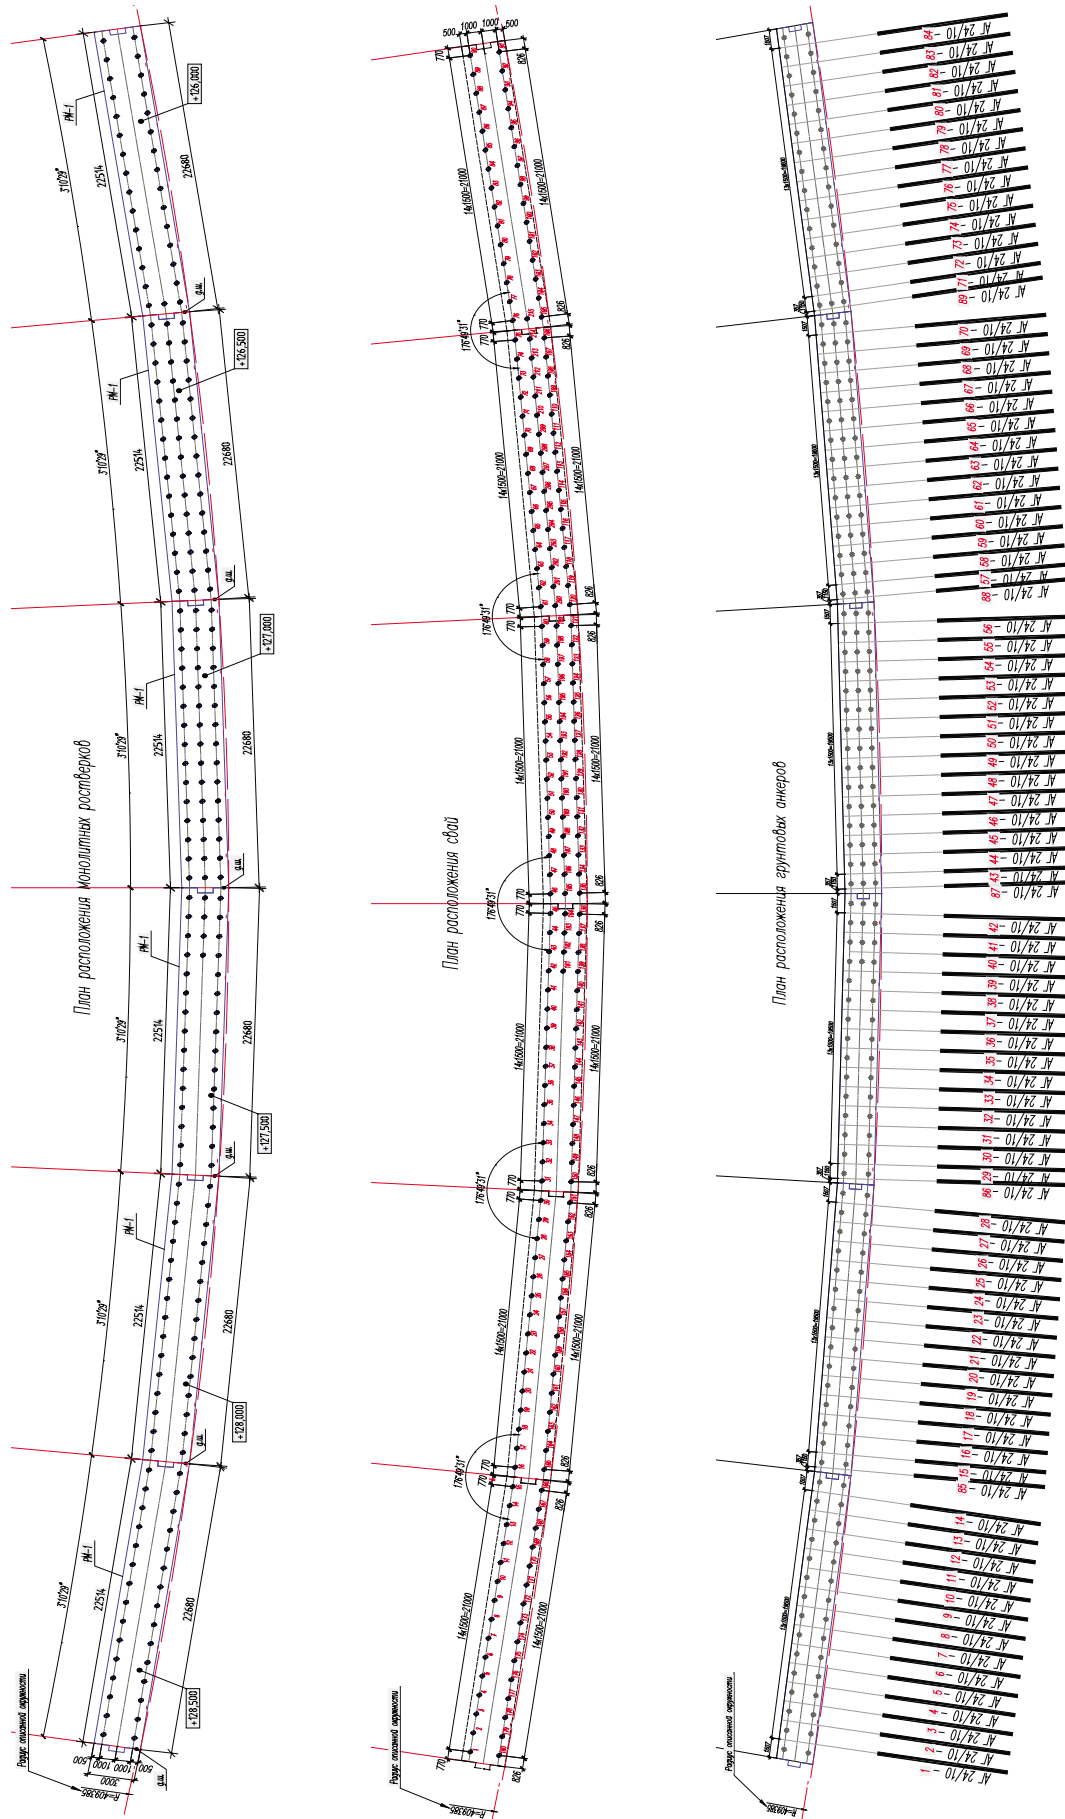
План расположения монолитных ростверков. План расположения свай. План расположения грунтовых анкеров
